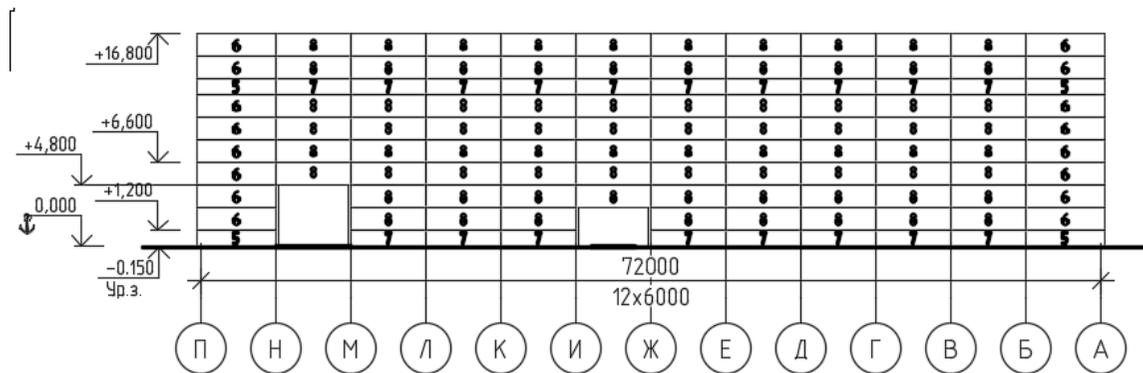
Схема расположения стеновых панелей на фасаде П-А
